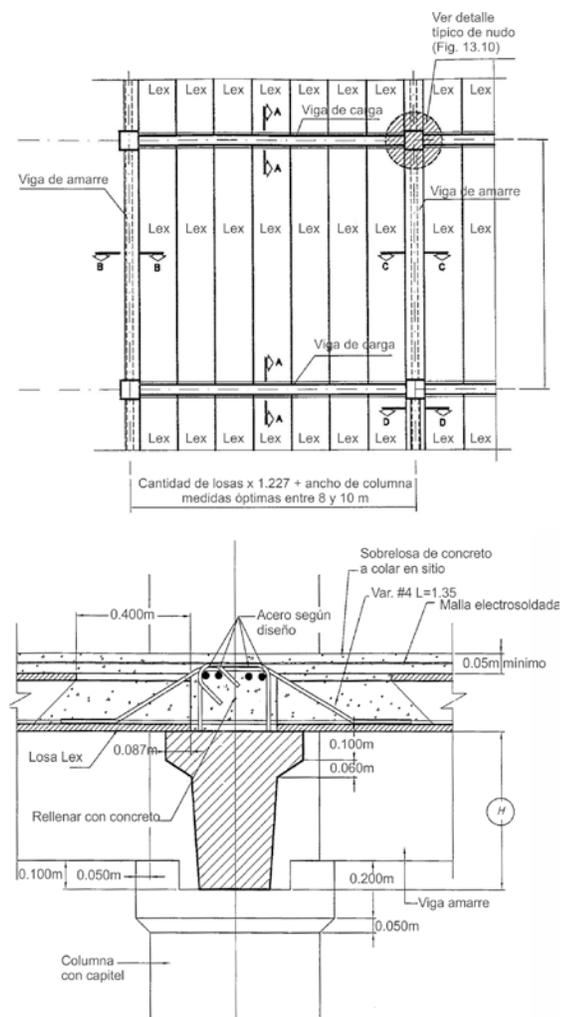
Planta típica de entresijos y sección A-A conexión de la viga de carga con el entresijo.
